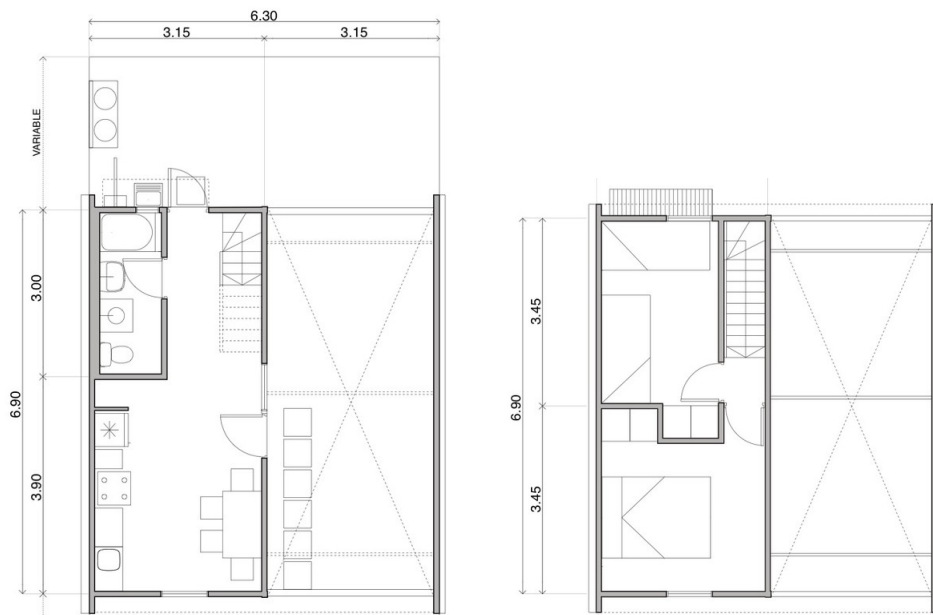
Planta do projeto Villa Verde. Fonte: ArchDaily: Habitação Villa Verde / ELEMENTAL
